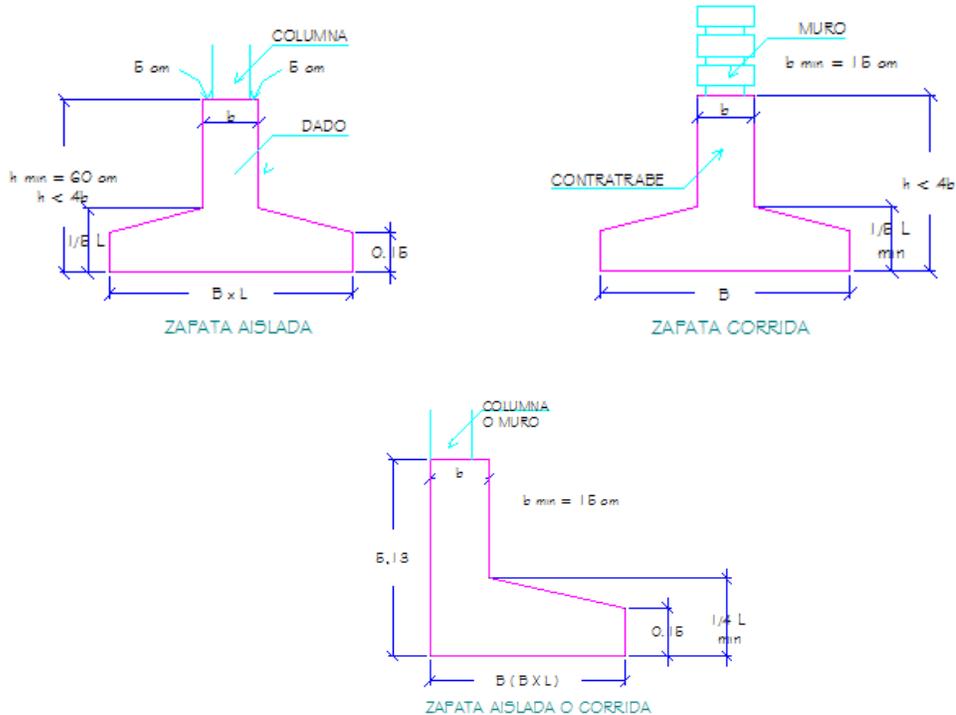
Croquis de zapata aislada. (Dibujo por Ruth Herrera Barriga.)
